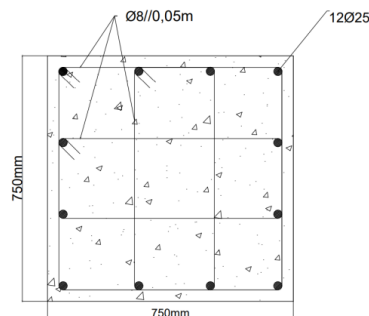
Pormenor construtivo da secção transversal do Pilar 1 na ligação entre o piso das fundações e o piso 1, utilizando o software Autodesk AutoCAD [64]
